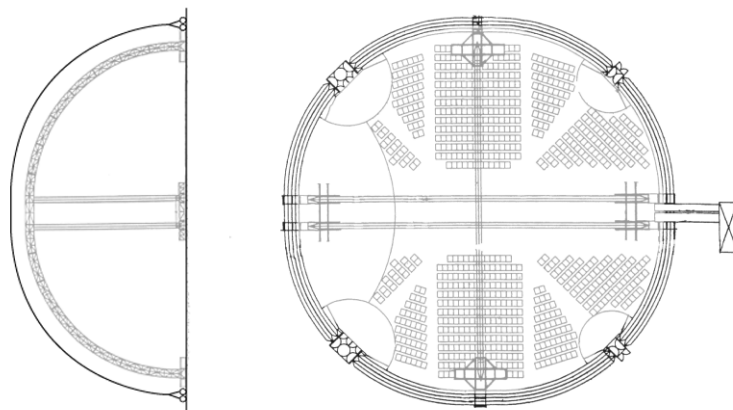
Querschnitt, Grundriss (9)
